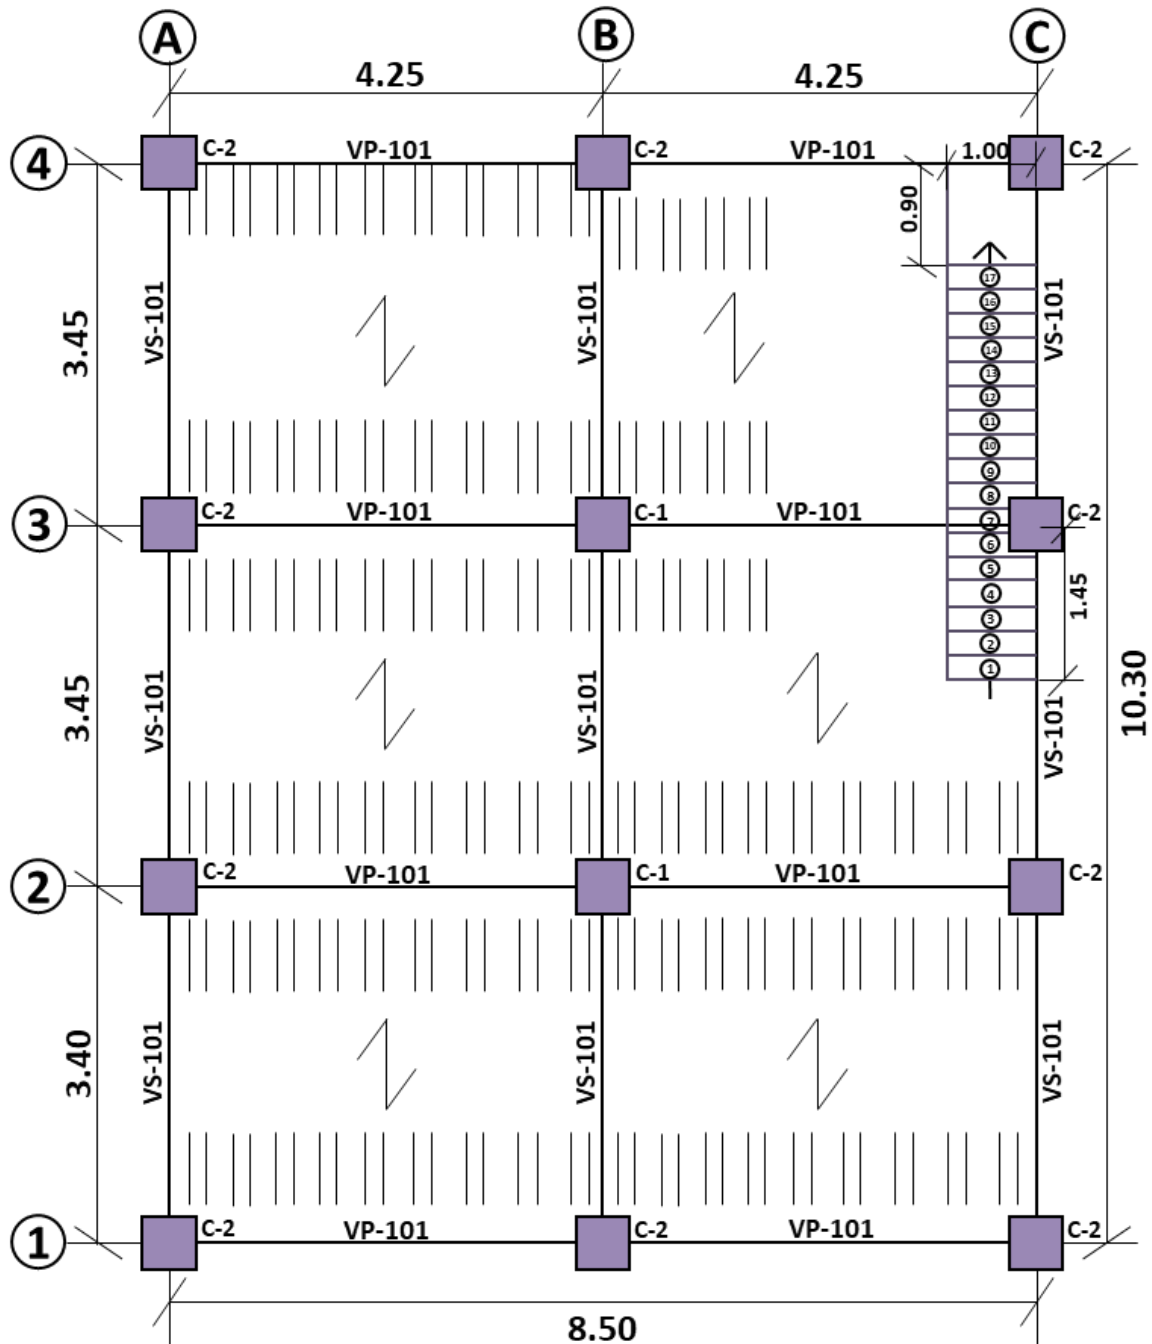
Figura I: Plano de estructuración de la edificación. Fuente: Elaboración propia (2024).
